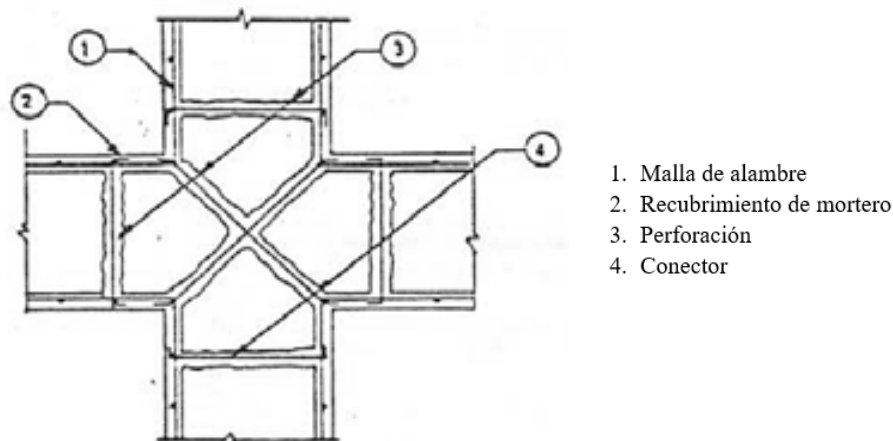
Detalle de la colocación de malla en muros ortogonales (Ruiz, 1995)
